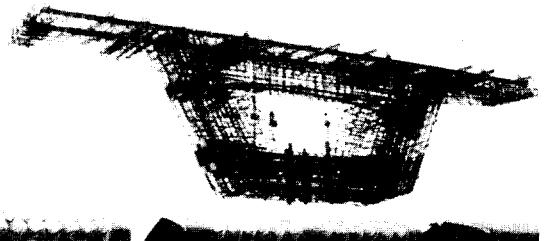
절근 Cage를 Steel Mould로 운반하는 모습
